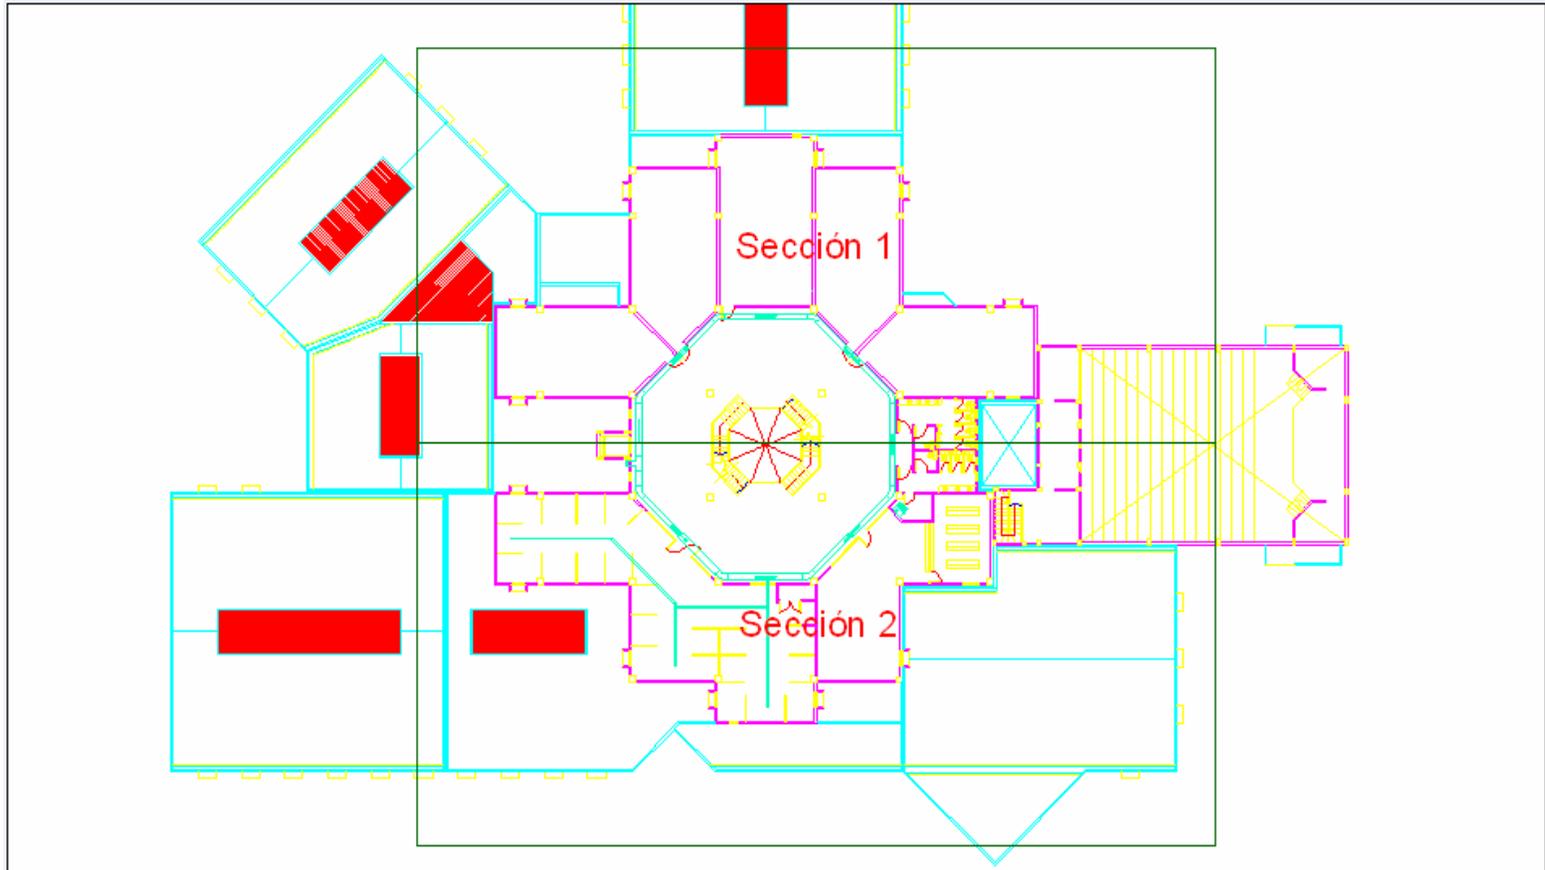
PLANO CLIMATIZACIÓN PRIMER PISO GENERAL
